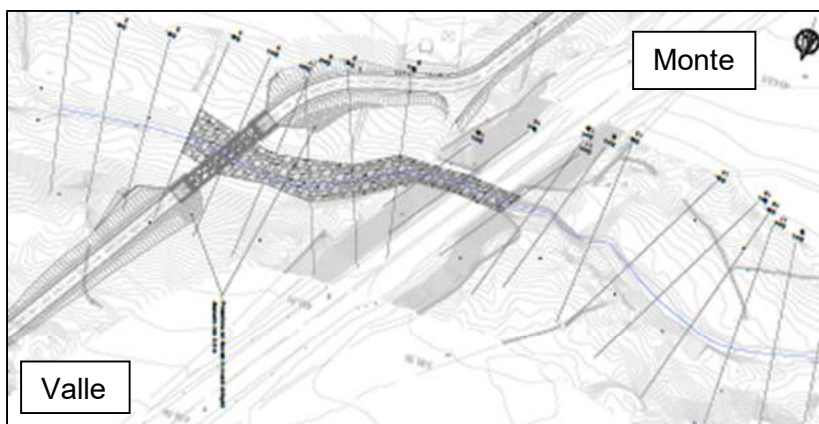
Stralcio planimetrico di inquadramento dell'attraversamento sul Riu Murtazzolu tramite ponticello idraulico
